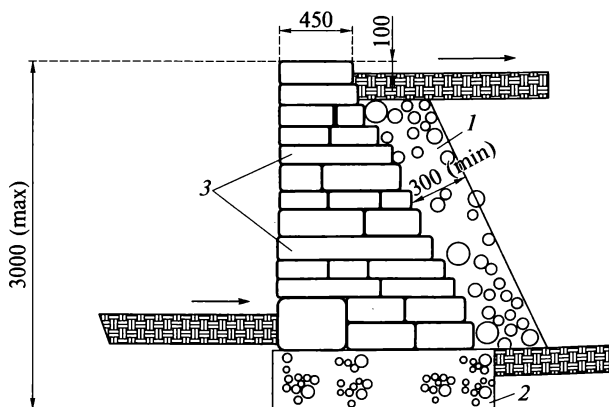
Конструкция подпорной стенки из камня — «сухая кладка»:
